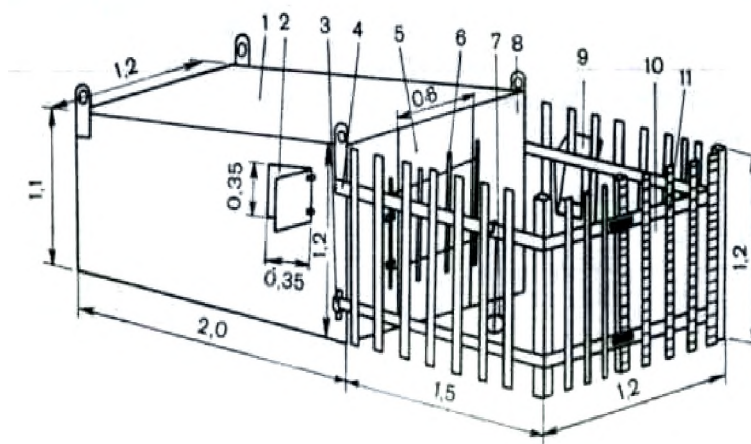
Индивидуальный домик для содержания телят на открытой площадке:
